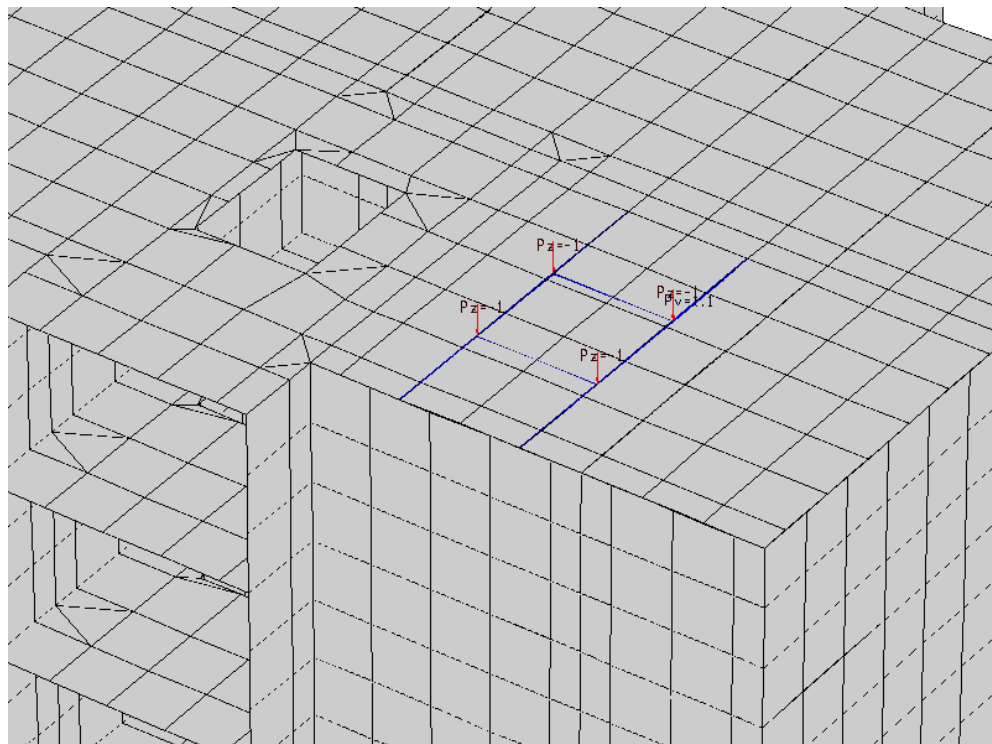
Нагрузки от ветровой установки ВЭУ-3 на покрытие
